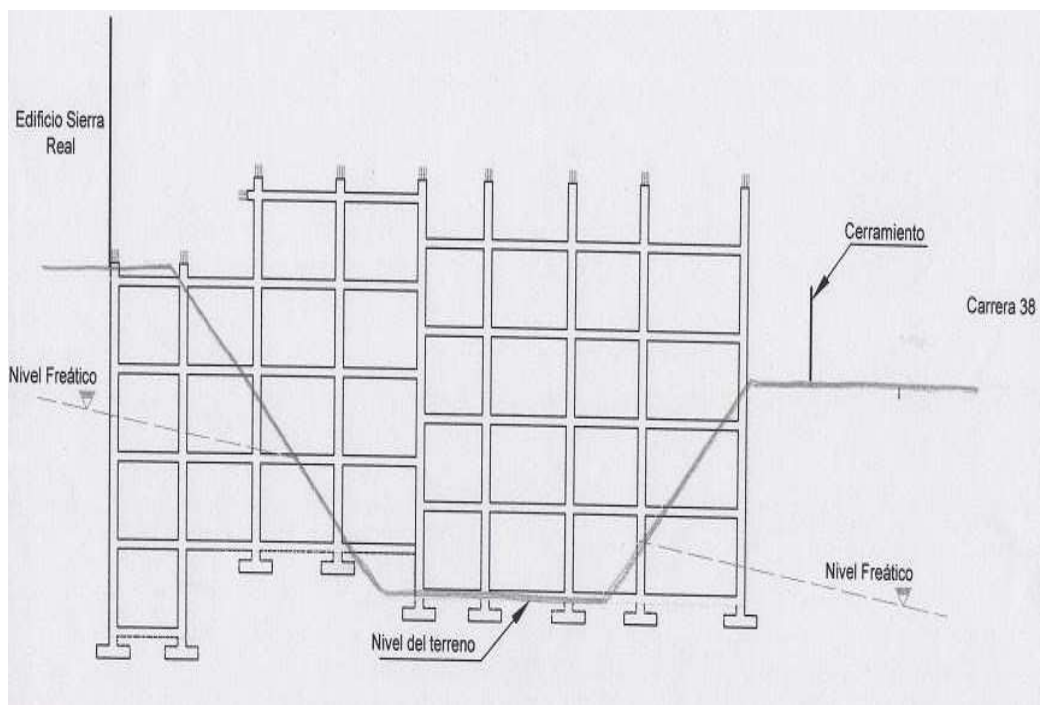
Diagrama 9 Construcción cimentación, Estudio geotécnico de suelo.
